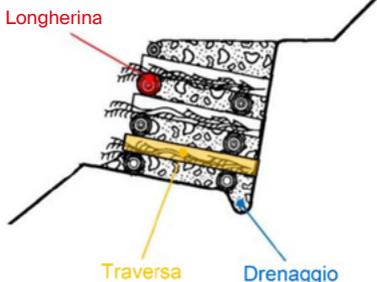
Sezione di un cassone doppio in legno (a due pareti)
